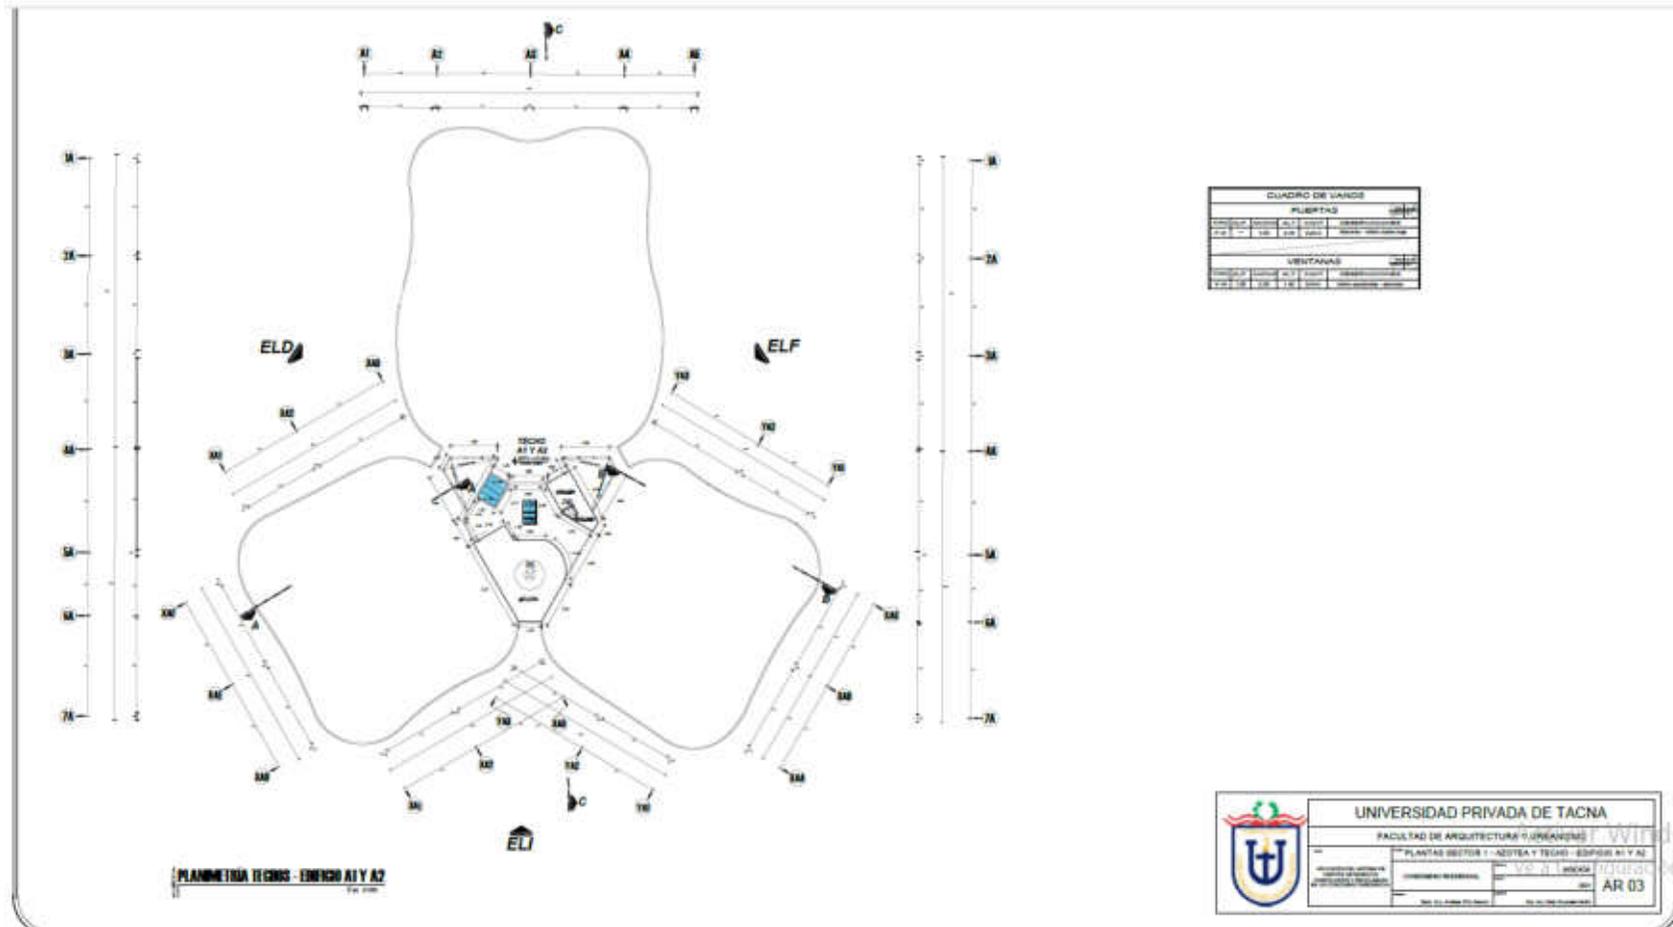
Planimetría de Techos– Edificio A1 y A2 – Sector 1
